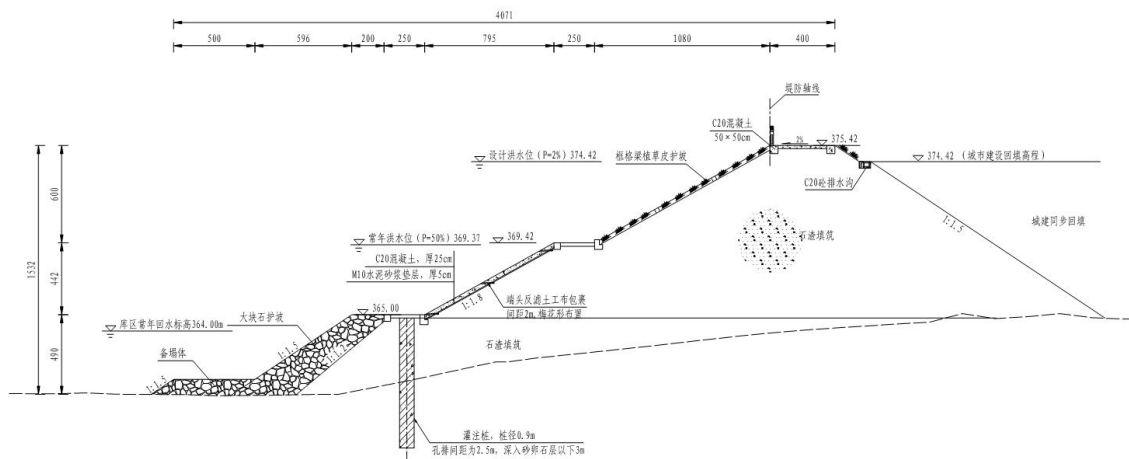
方案三：现浇砼面板斜坡堤（钢筋混凝土灌注桩处理）典型布置形式图
